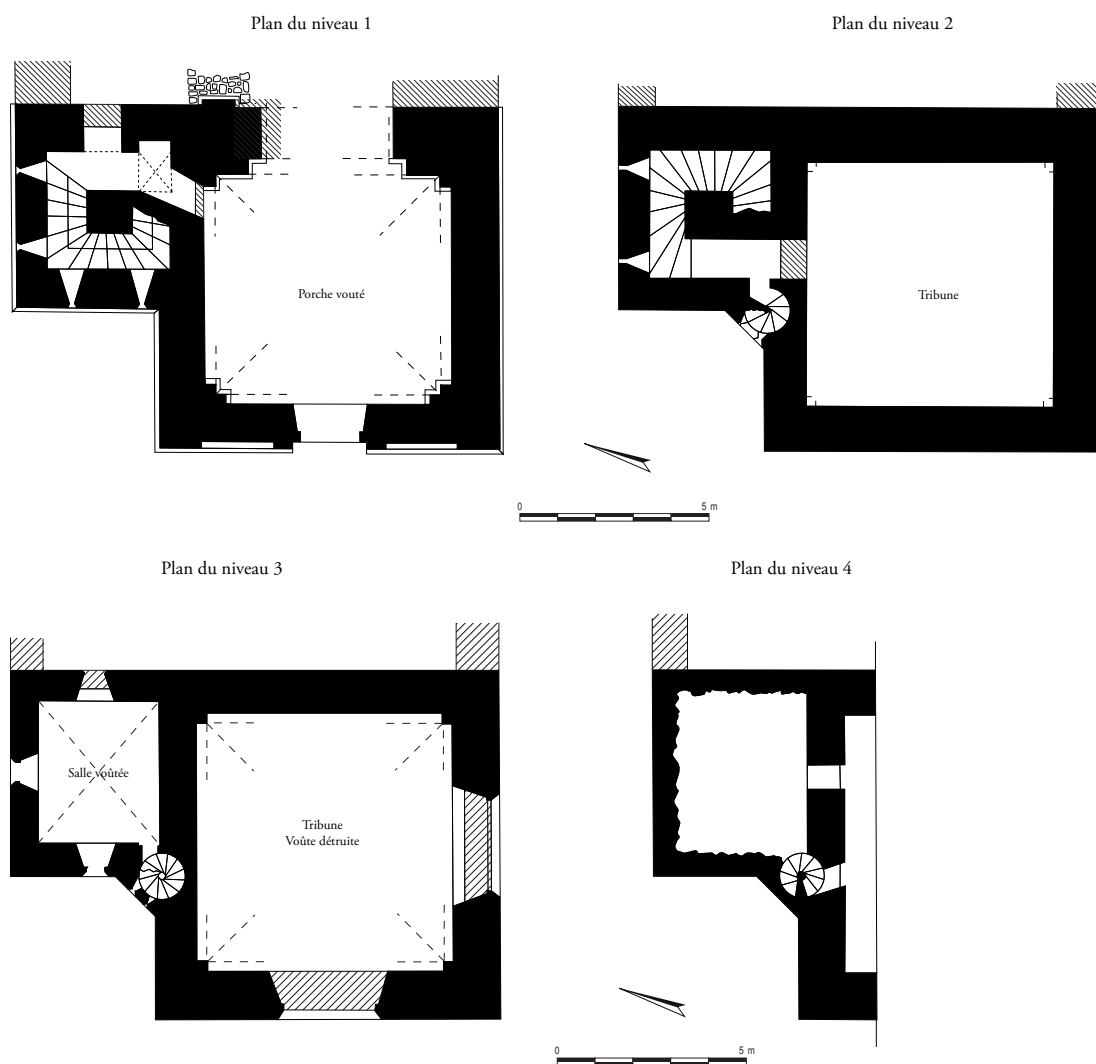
Plans des quatre niveaux de la tour-porche (relevé Pierre Simonin).
